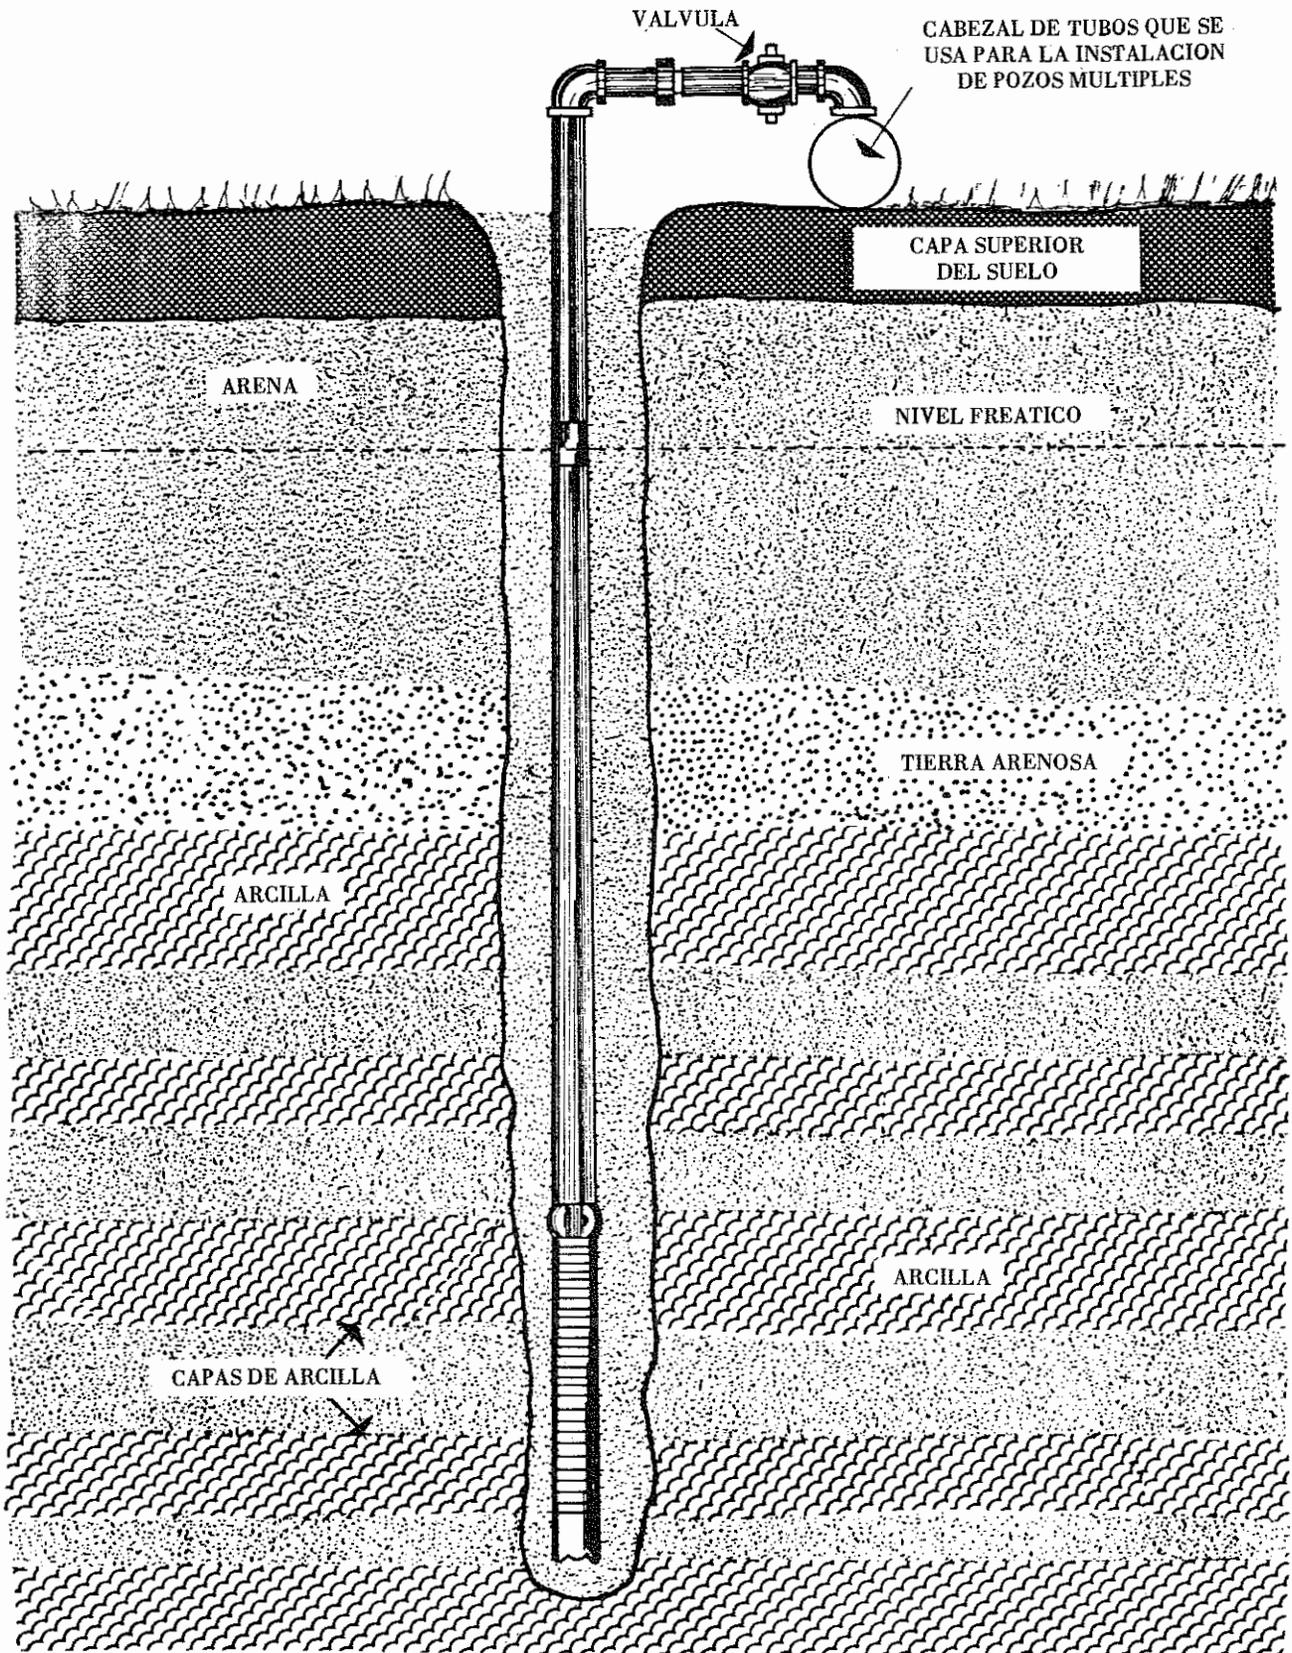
Sección Transversal de un Pozo Excavado por Chorro
